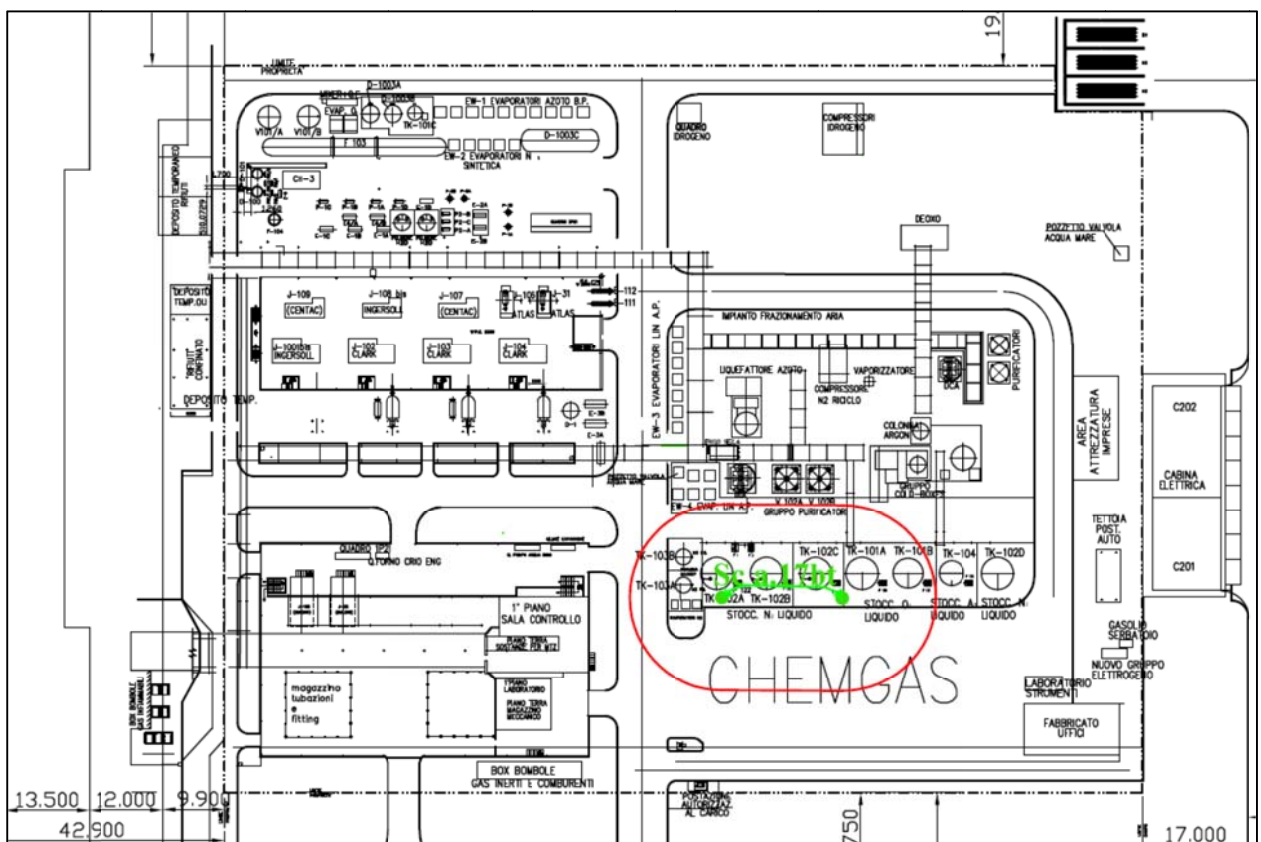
Stralcio della Planimetria limiti proprietà impianto – Dispersione Azoto Rottura Parziale F2
